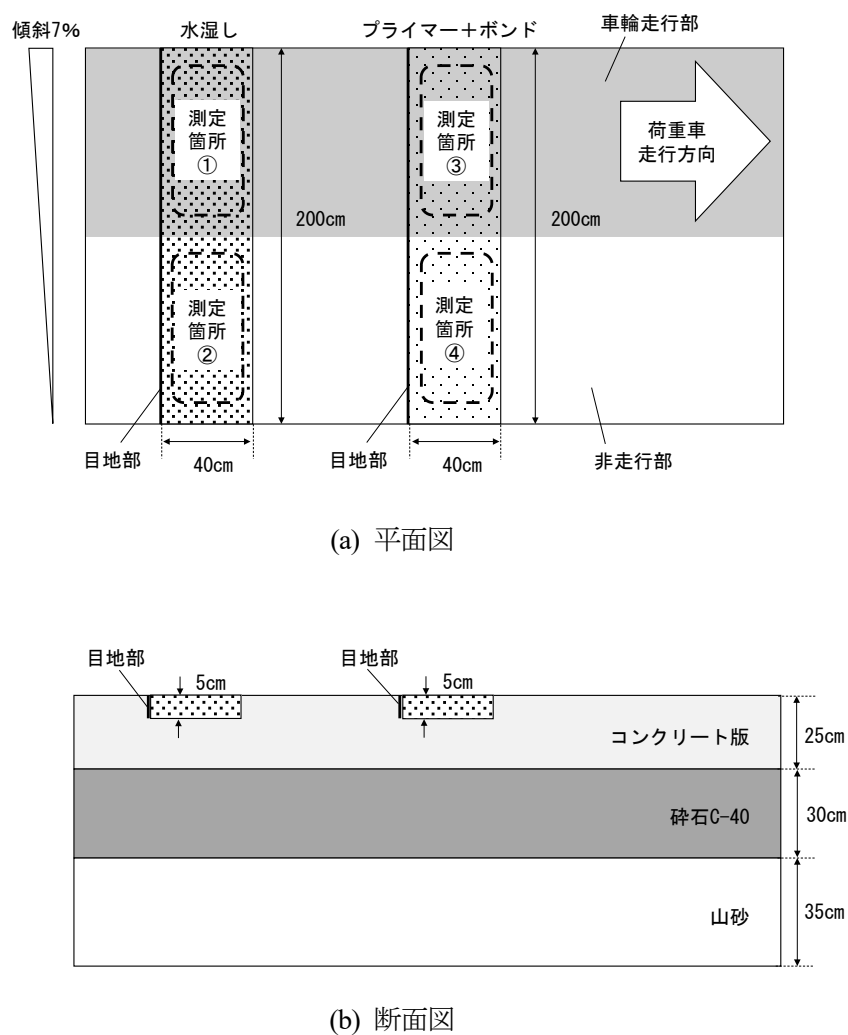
コンクリート舗装区間の構造および補修箇所の概要
